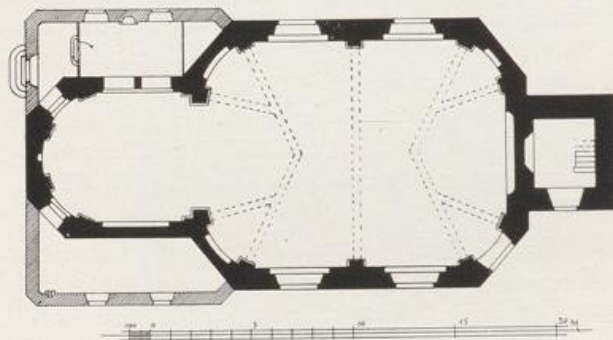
Müddersheim. Grundriss der kath. Pfarrkirche.
